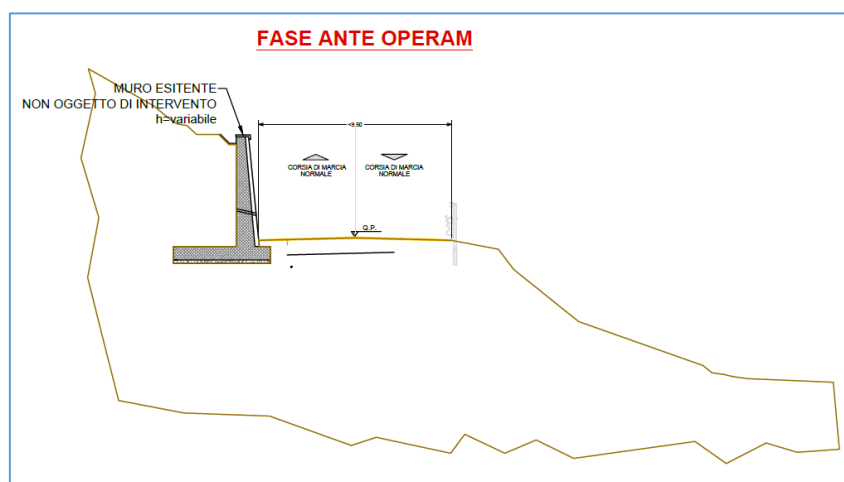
a–Sezione tipo 2 – Ante Operam
